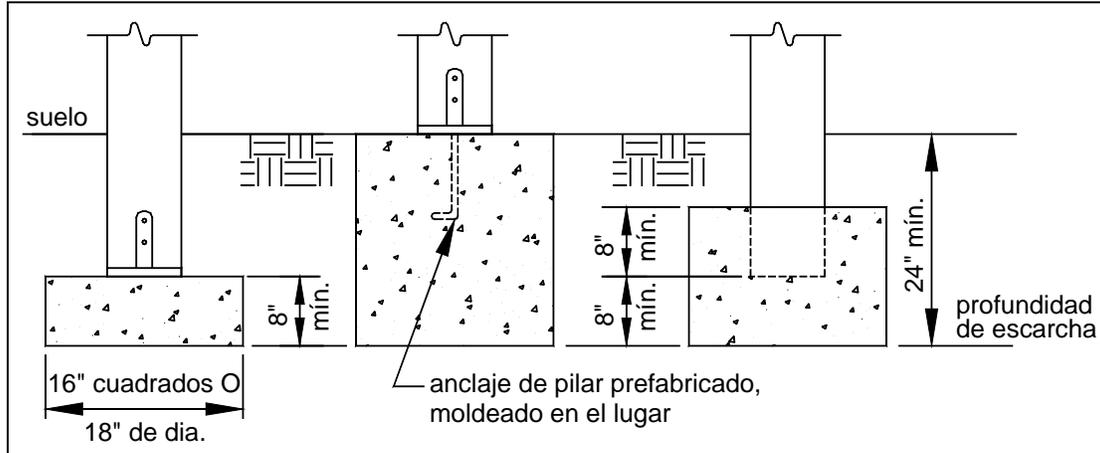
DETALLE DE APOYO DE LA CIMENTACIÓN TÍPICO
